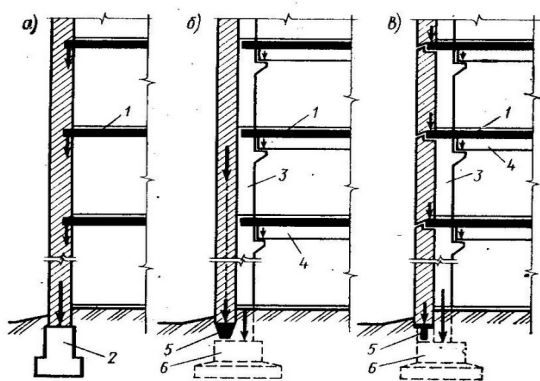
Виды наружных стен: а – несущие; б, в – несущие – самонесущие (б) и навесные (в); 1 – плита перекрытия; 2 – ленточный фундамент; 3 – колонна; 4 – ригель; 5 – фундаментная балка; 6 – столбчатый фундамент
